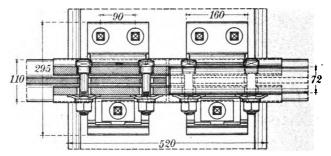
b. Grundriß und Aufsicht. M. 1:10.
